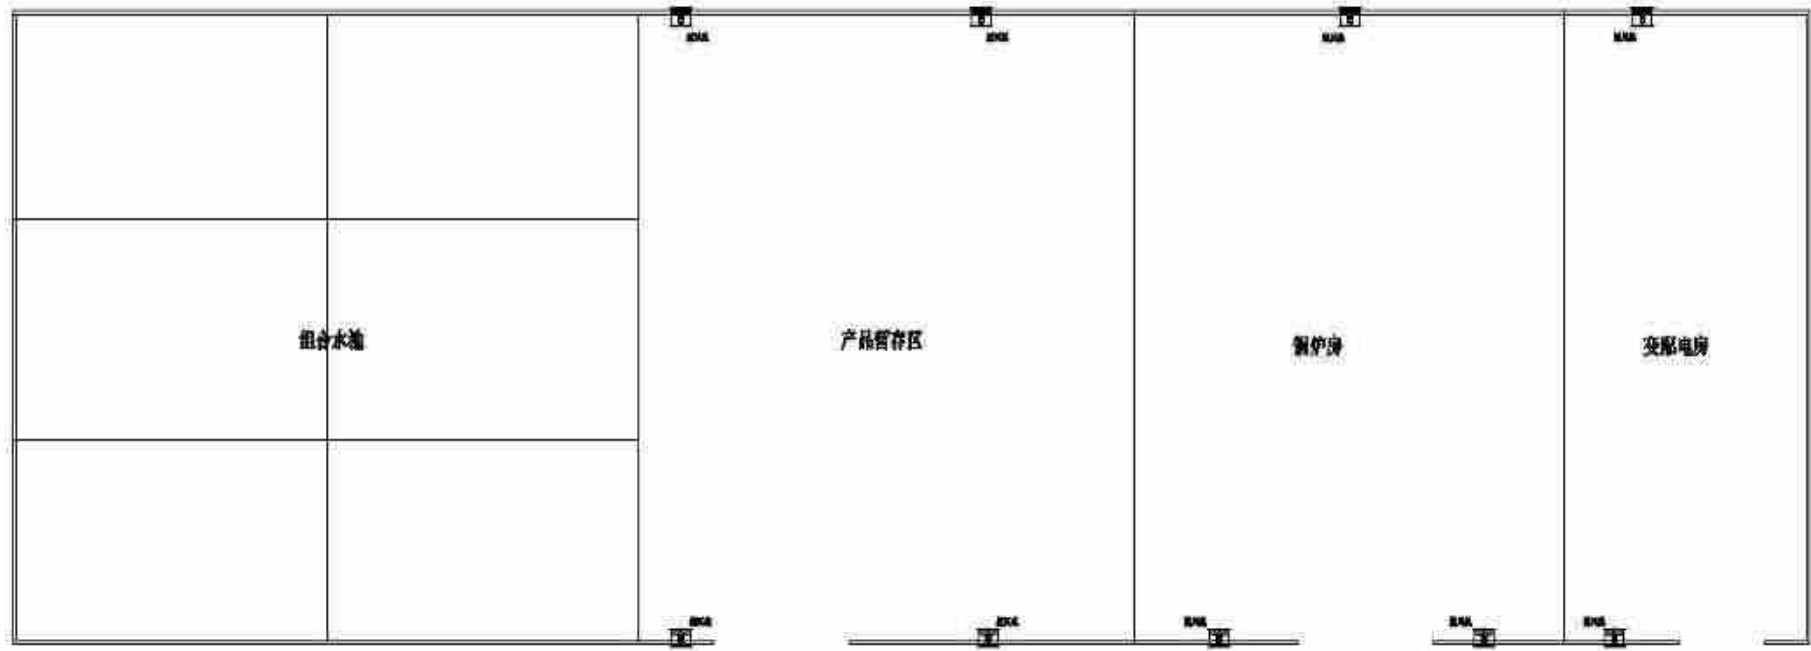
本次改扩建后 2#厂房及其西侧组合水池平面布置图
